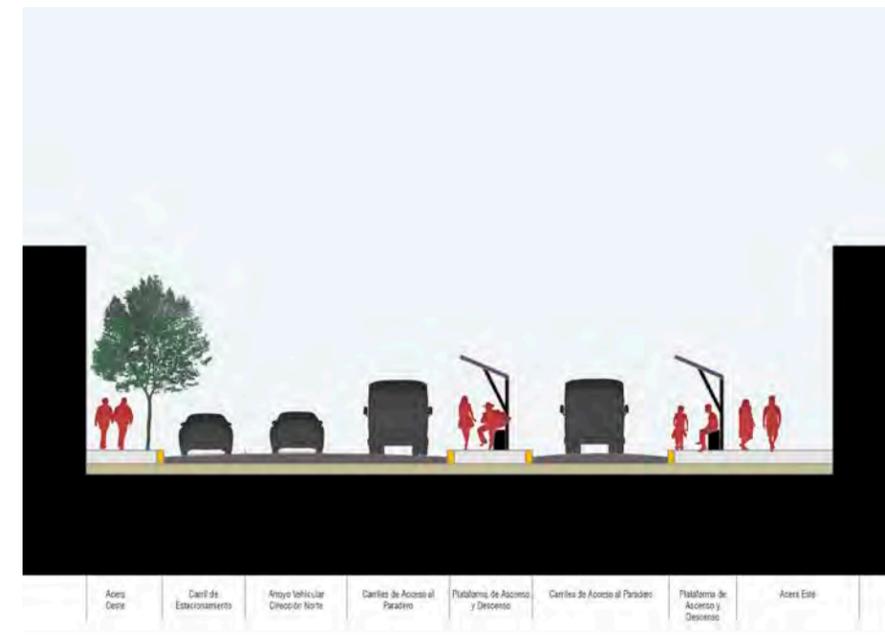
Corte del paradero sur ubicado en la calle Río Becerra.
